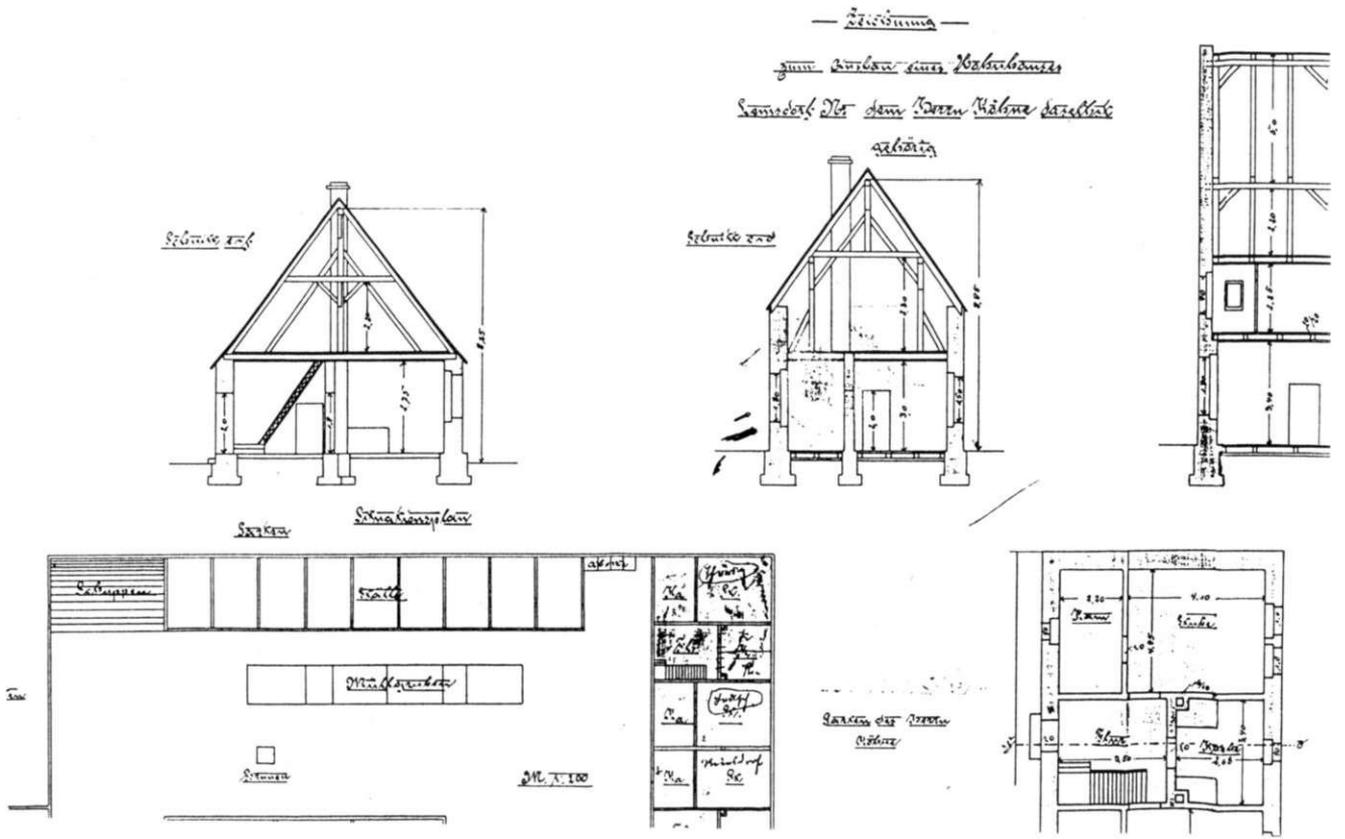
Grundriß und Schnitt zum Umbau des Hauses Im Winkel Nr. 2, 1830, Bauherr Köhne
